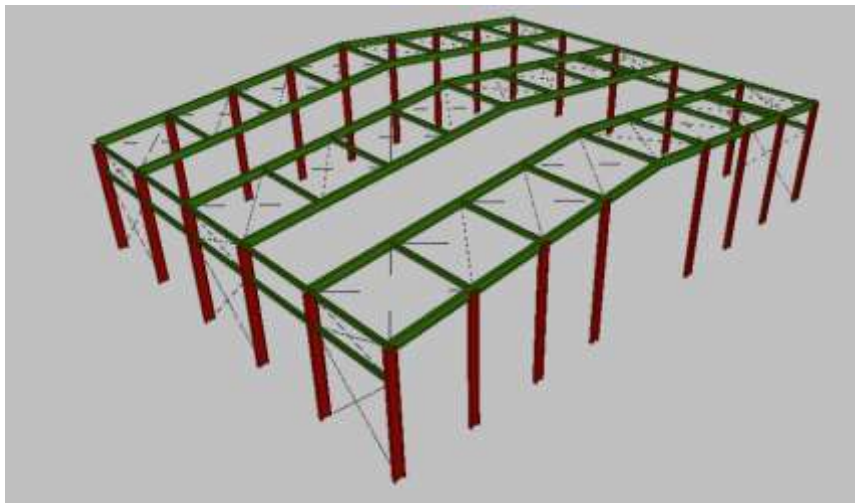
D de la estructura completa. Fuente-CYPE
